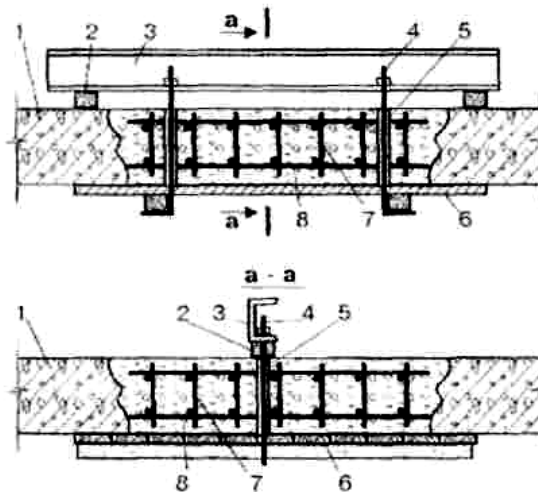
Схема влаштування монолітного перекриття з використанням складної опалубки:
